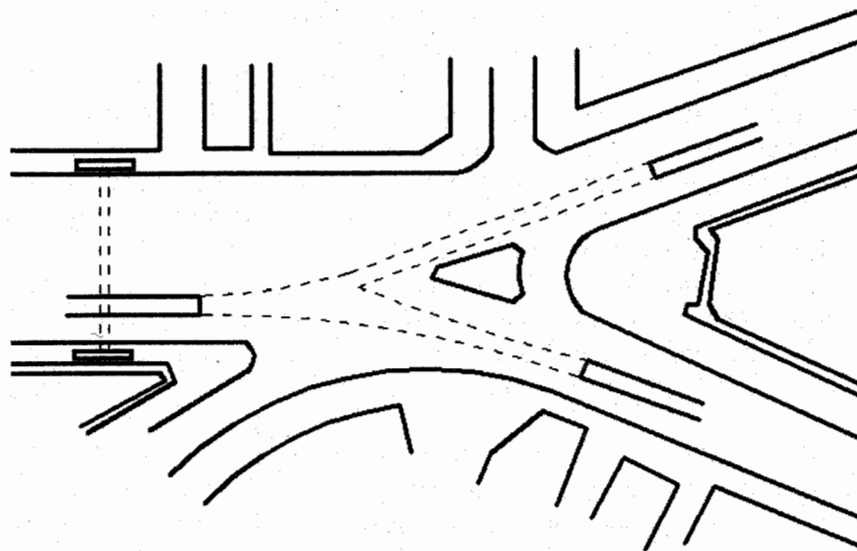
Планировочная схема разветвляющегося туннеля
